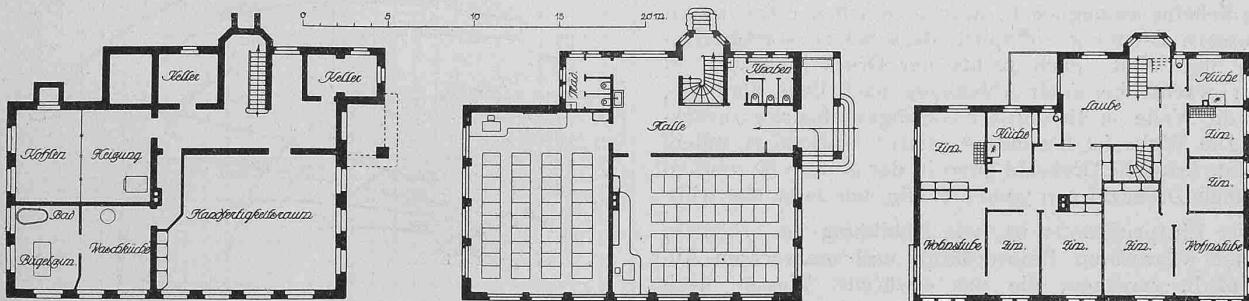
bis 3. Grundrisse vom Untergeschoß, Erdgeschoß und I. Stock des Schulhauses Ober-Dürnten. — Maßstab 1 : 400.
